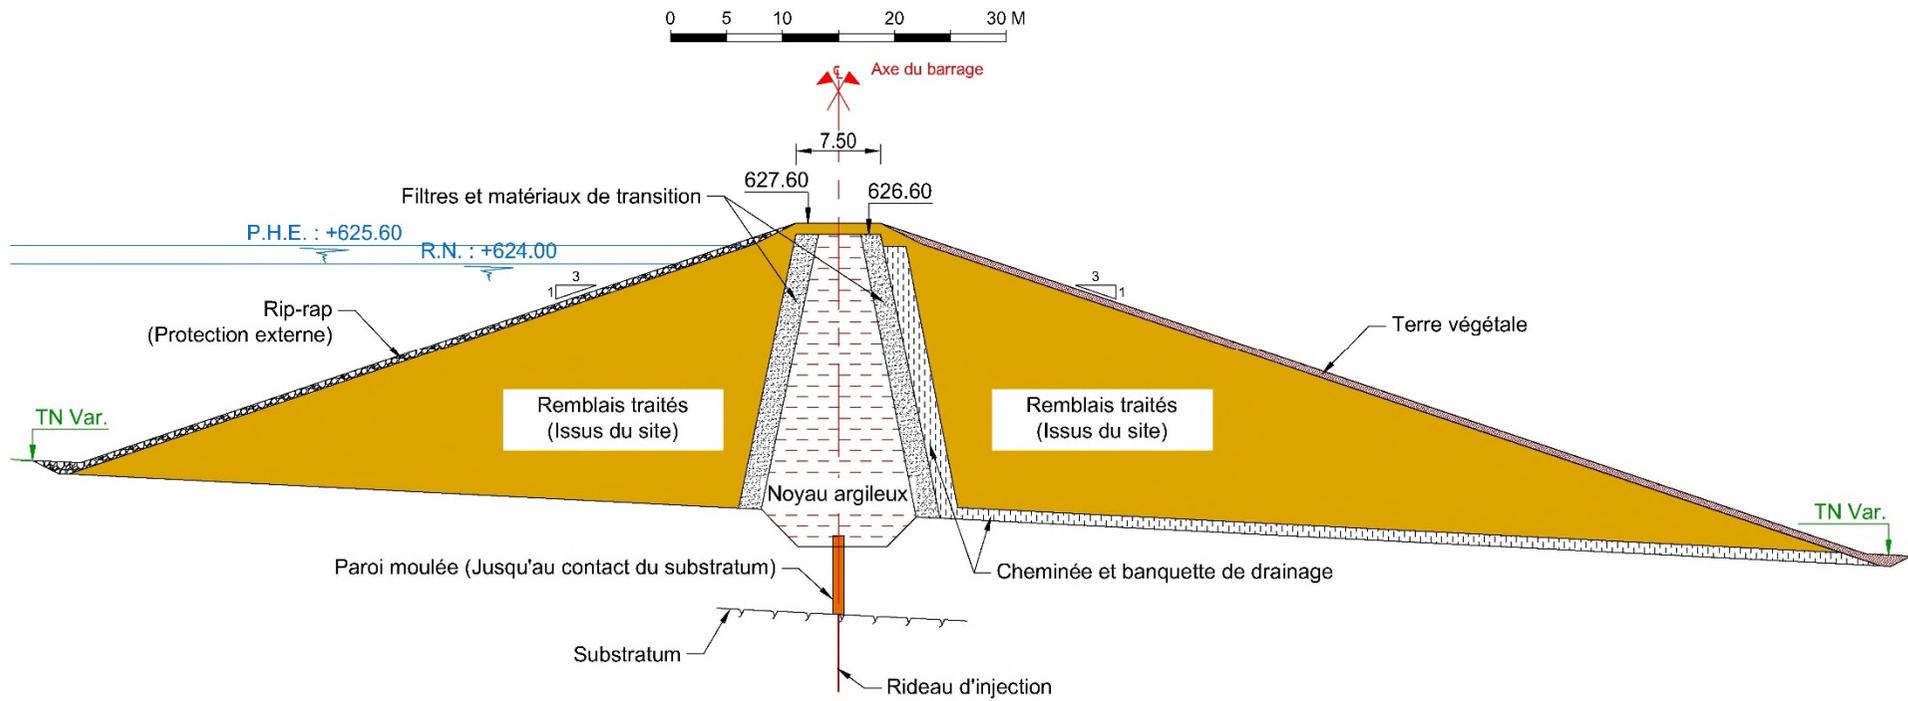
Coupe-type du nouveau barrage sur la Lauch
